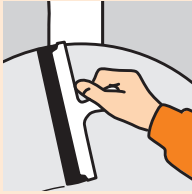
Anschluss Wand-Estrich im Wasser beanspruchten Bereich
